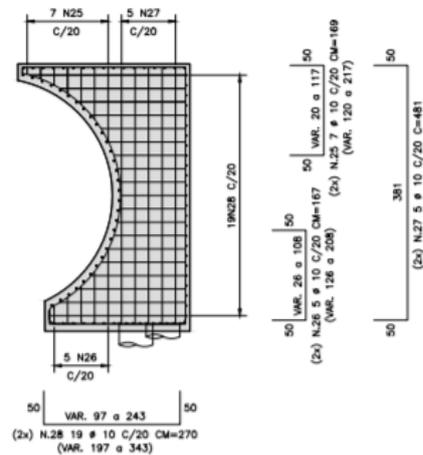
Vista lateral do muro. Fonte: DER, 2021.
